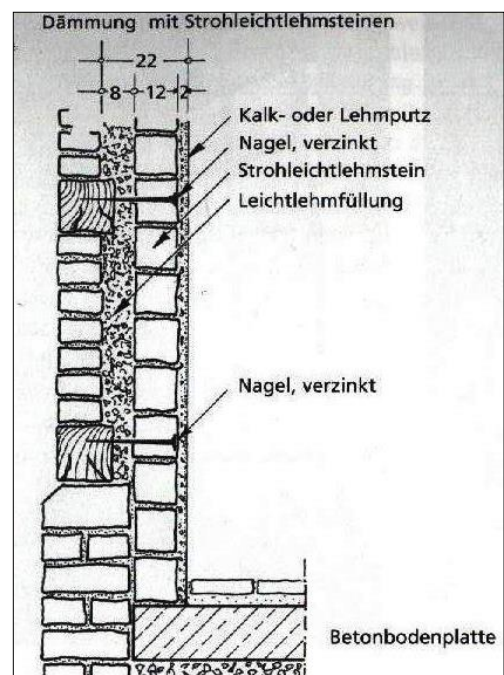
Restauració de la façana amb doble fulla i omplert d'argila.
